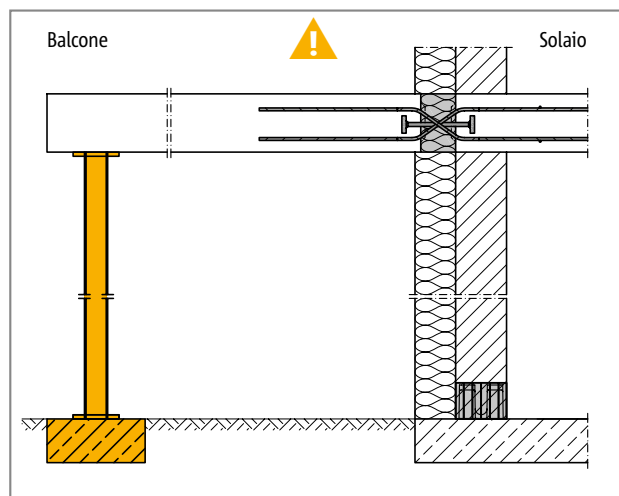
Schöck Isokorb® tipo QPXT+QPXT: è necessario un appoggio continuo
